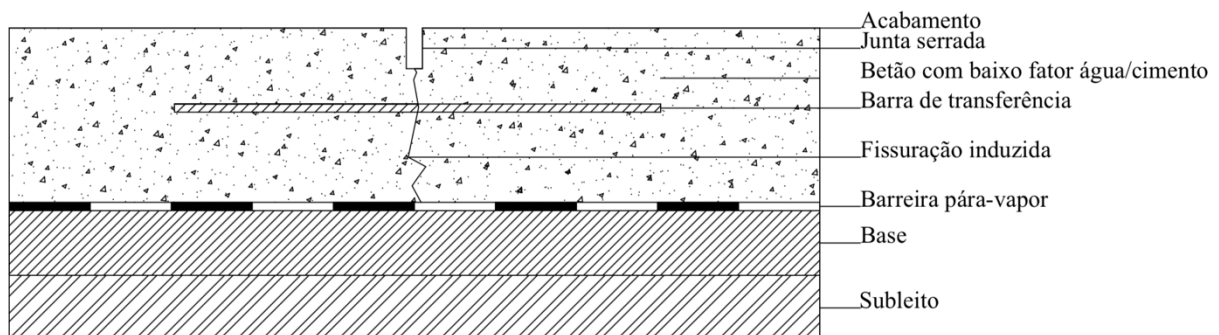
Pavimento de betão simples com barra de transferência [adaptado 34]
